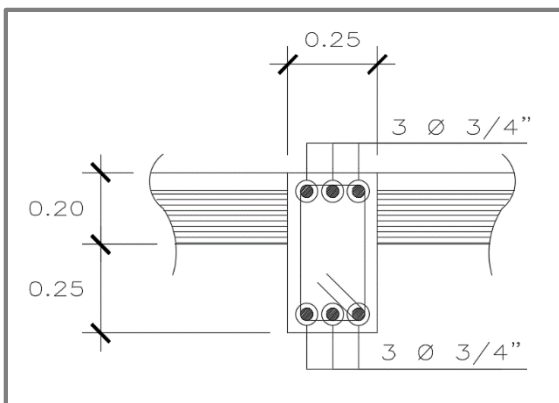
Detalle del acero longitudinal de la Viga 25X45-corte 3-3
